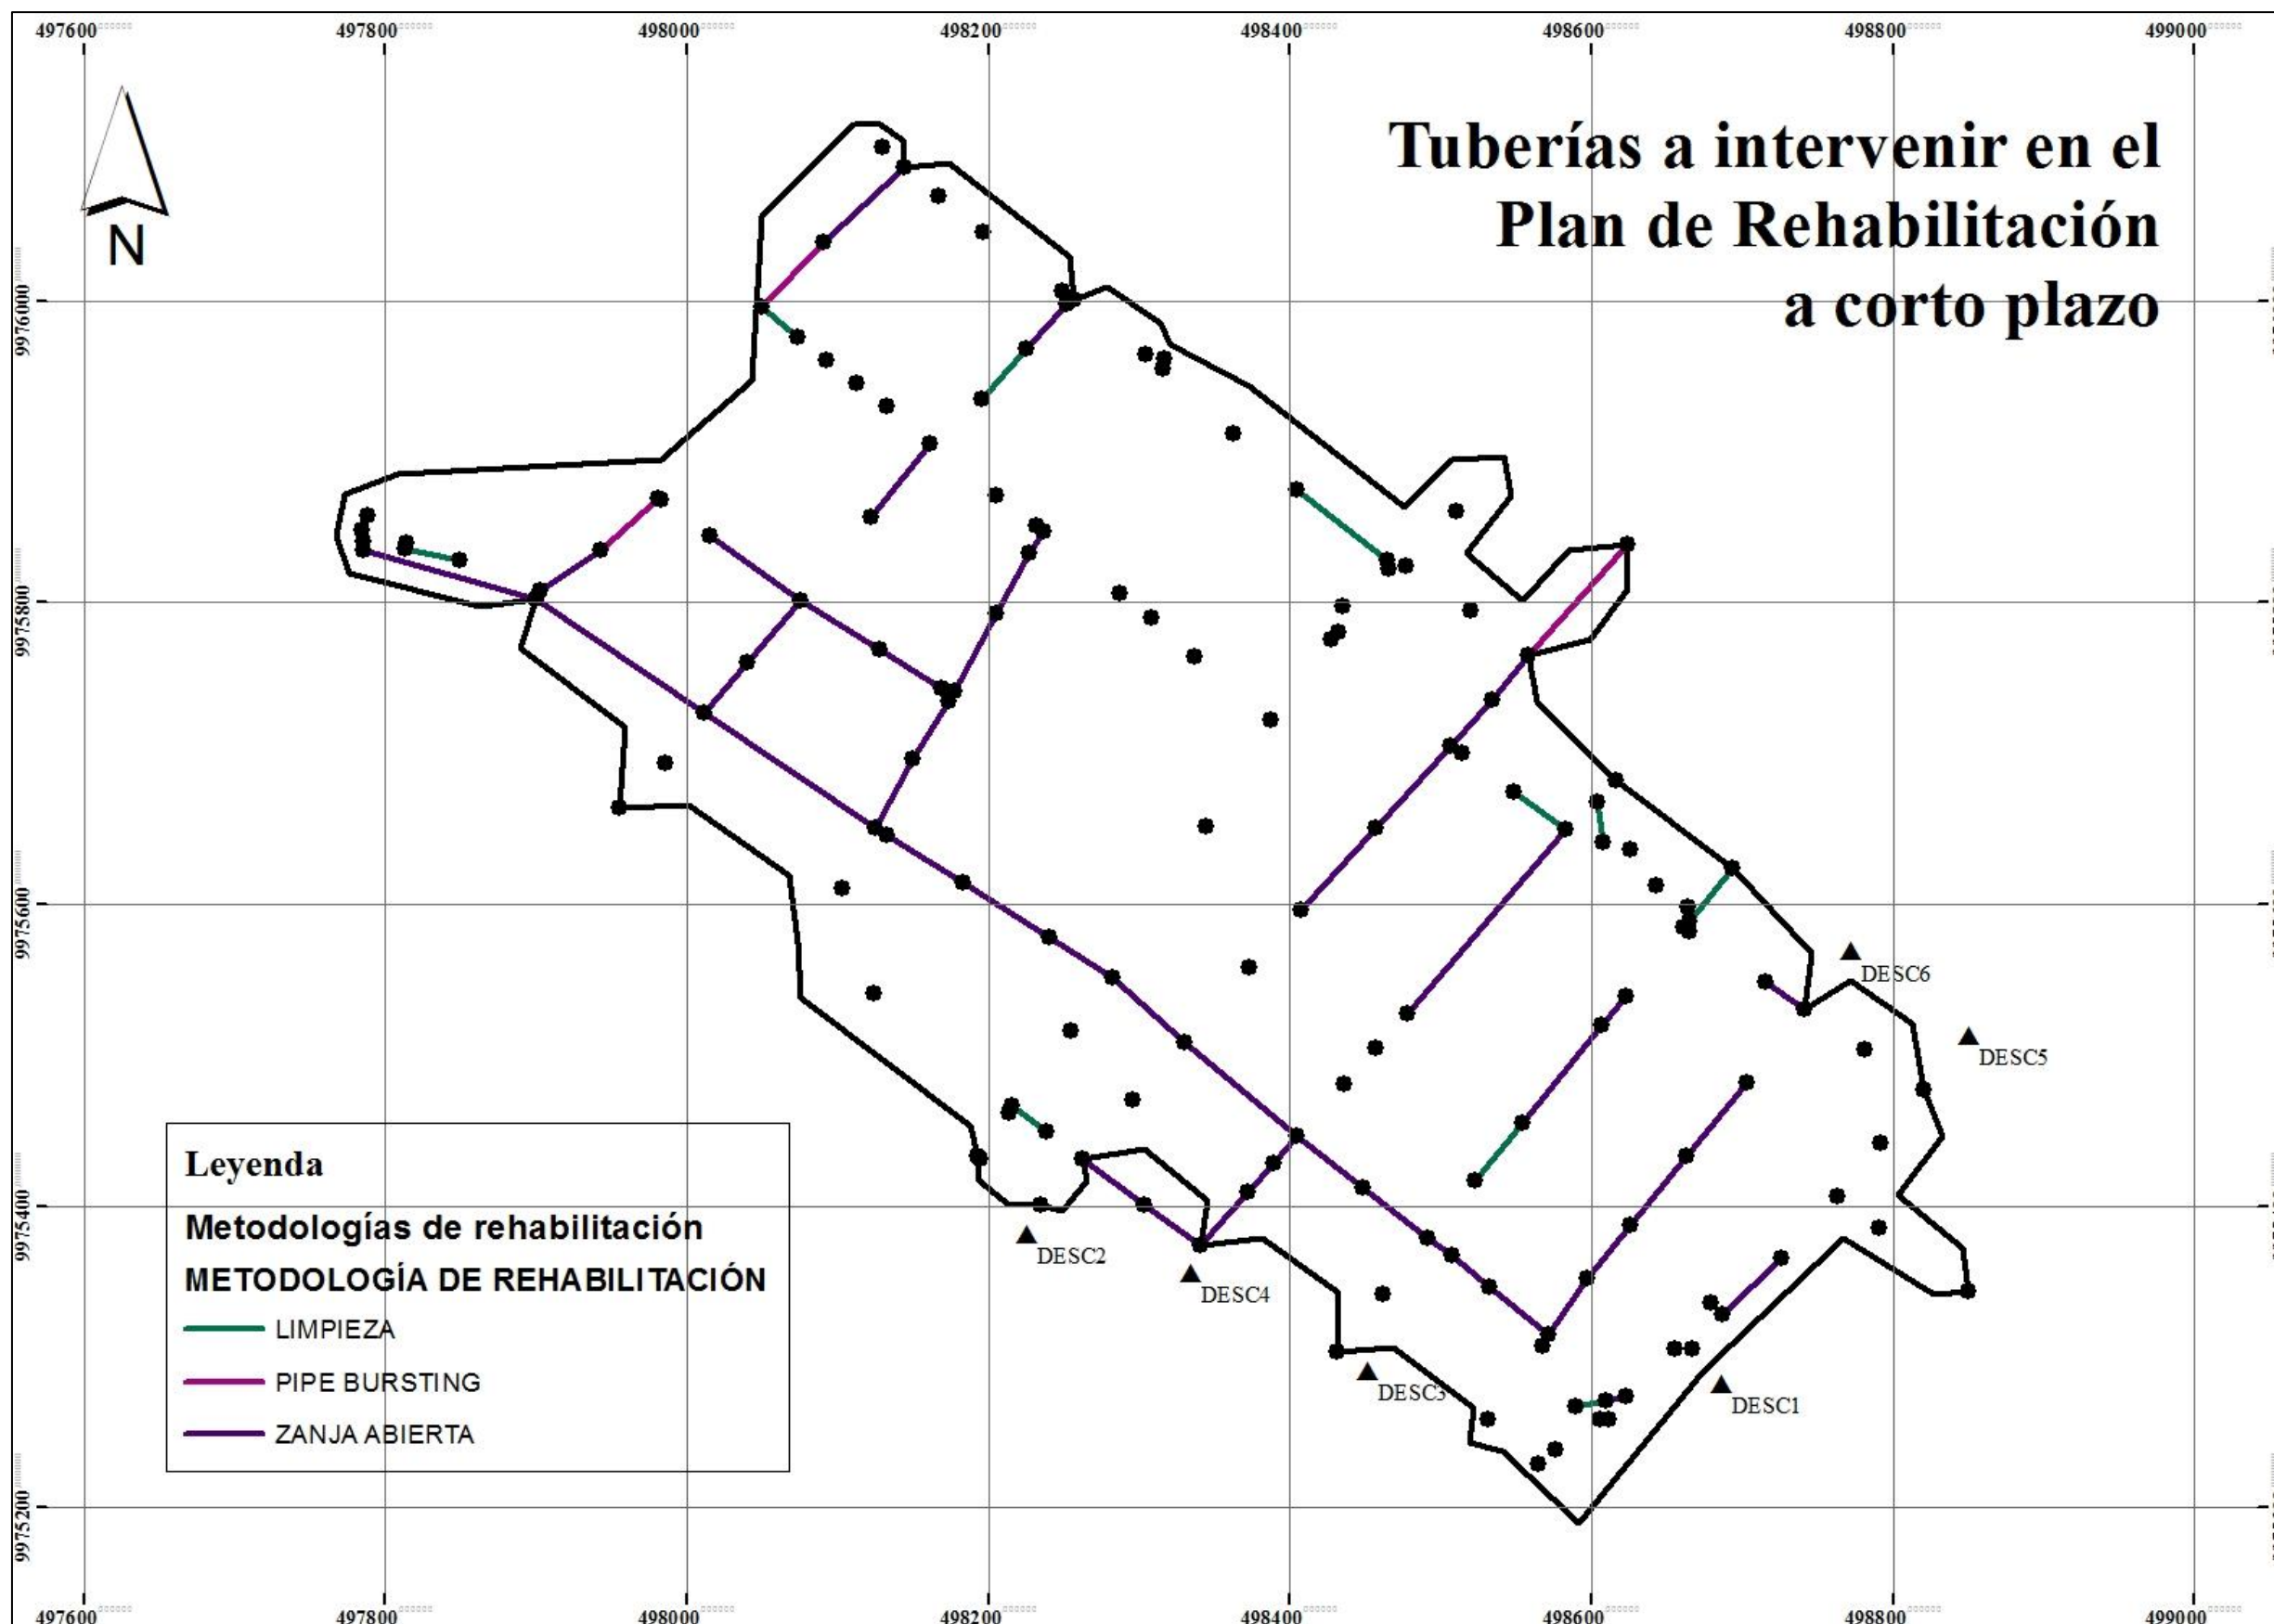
Tuberías a intervenir en el Plan de Rehabilitación a corto plazo
